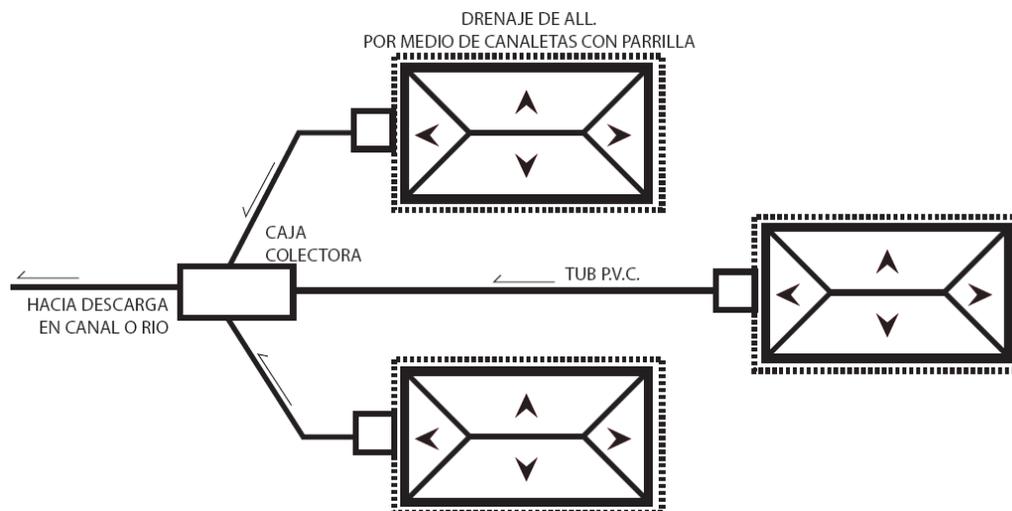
Detalle típico de drenaje de A.L.L., hacia canal o río más cercano.
